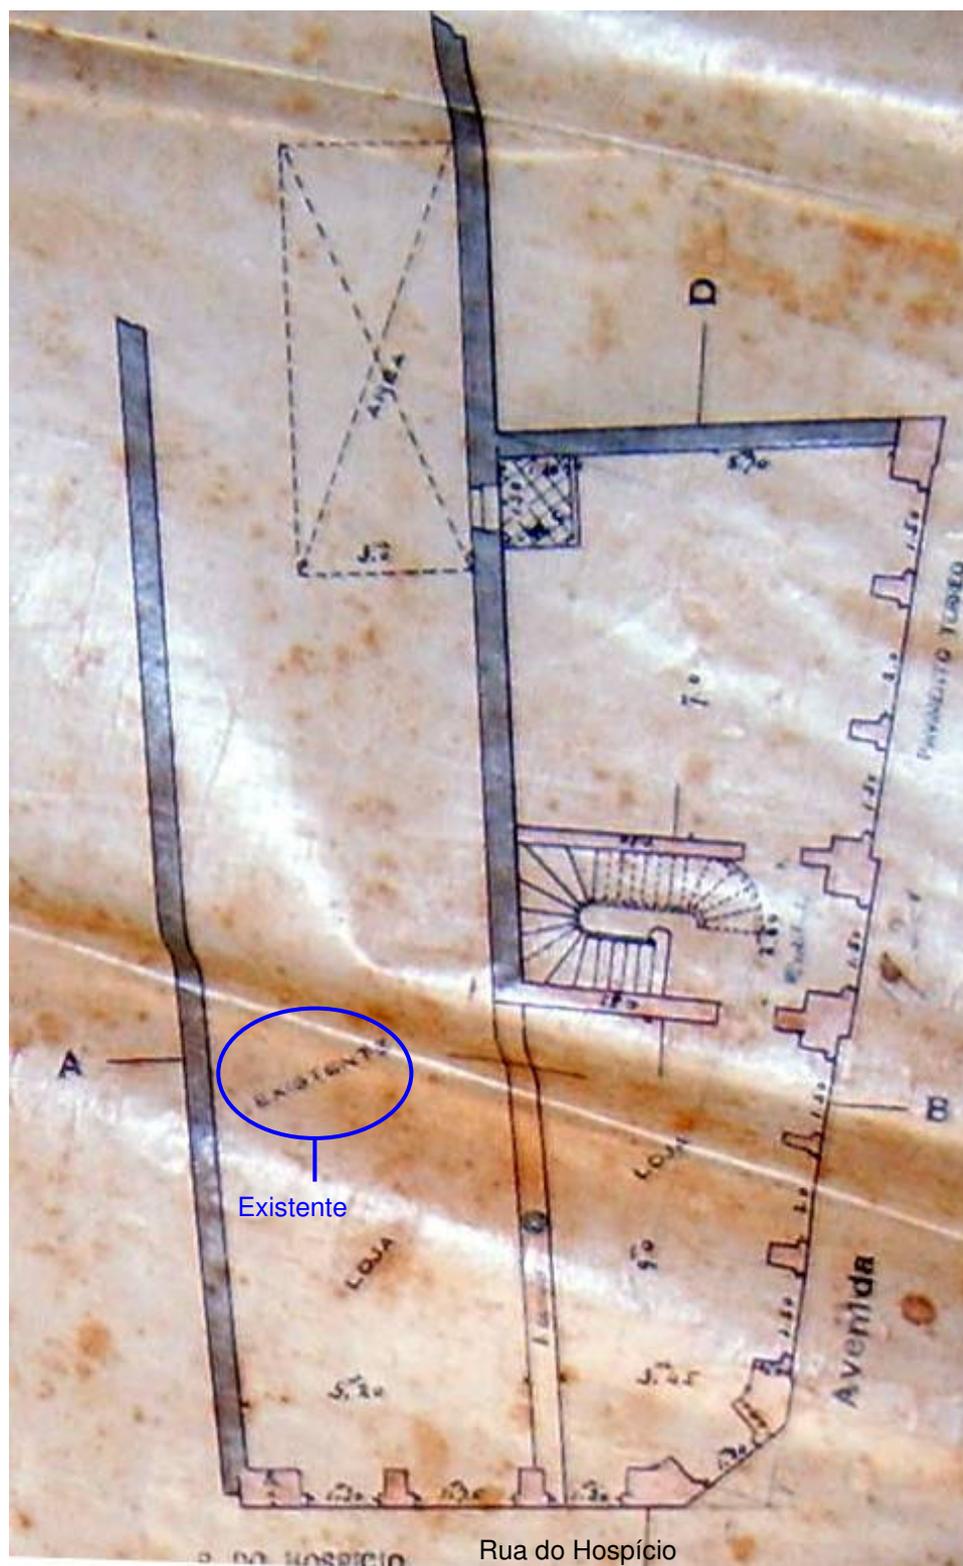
Plantas baixa do prédio nº 99/101, projeto de Manoel Joaquim de Oliveira; pode ser observado que parte da edificação está grafada como existente e é clara a alteração da parede estrutural proposta entre a unidade existente e a parte nova para unificá-las, além da nova marcação das alvenarias de fachada, de maneira que a construção existente e a nova projetada sejam parte de uma mesma composição arquitetônica (Arquivo Nacional, fotografia da autora).
